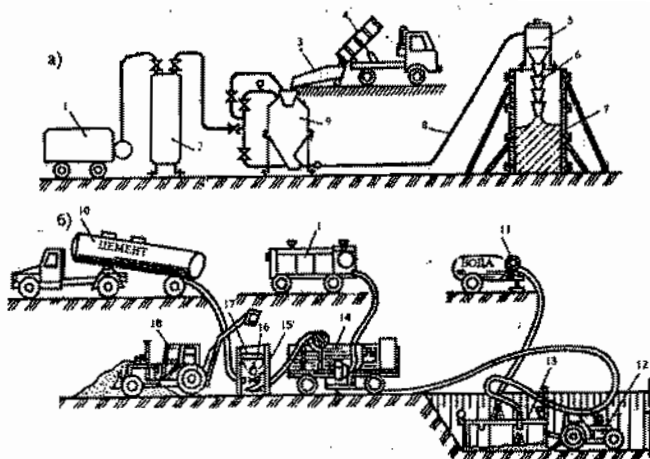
Укладка бетонной смеси пневмонагнетателями: 1 - компрессор; 2 - ресивер; 3 - вибропитатель; 4 - автобетоновоз; 5 - гаситель; 6 - хобот; 7 - опалубка; 8 - бетоновод; 9 - пневмонагнетатель; 10 - цементовоз; 11 - насос для подачи воды; 12 - трактор; 13 - устройство для ведения сопла; 14 - бетон-шприц-агрегат; 15 - дозатор; 16 - бункер; 17 - виброгрохот; 18 - экскаватор-бульдозер
